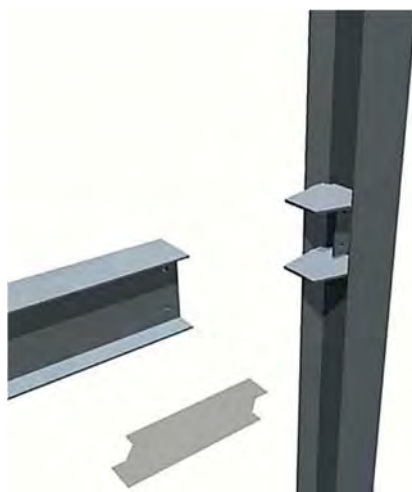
Conexión a momento completamente soldada llegando al eje débil de columna IR
